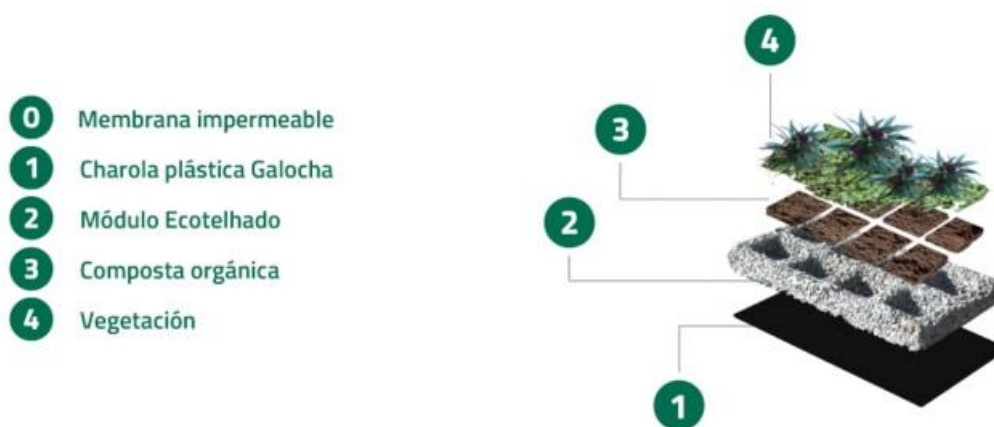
Sistema modular Ecotejado. Fuente: <http://plantica.mx/ecotejado>
